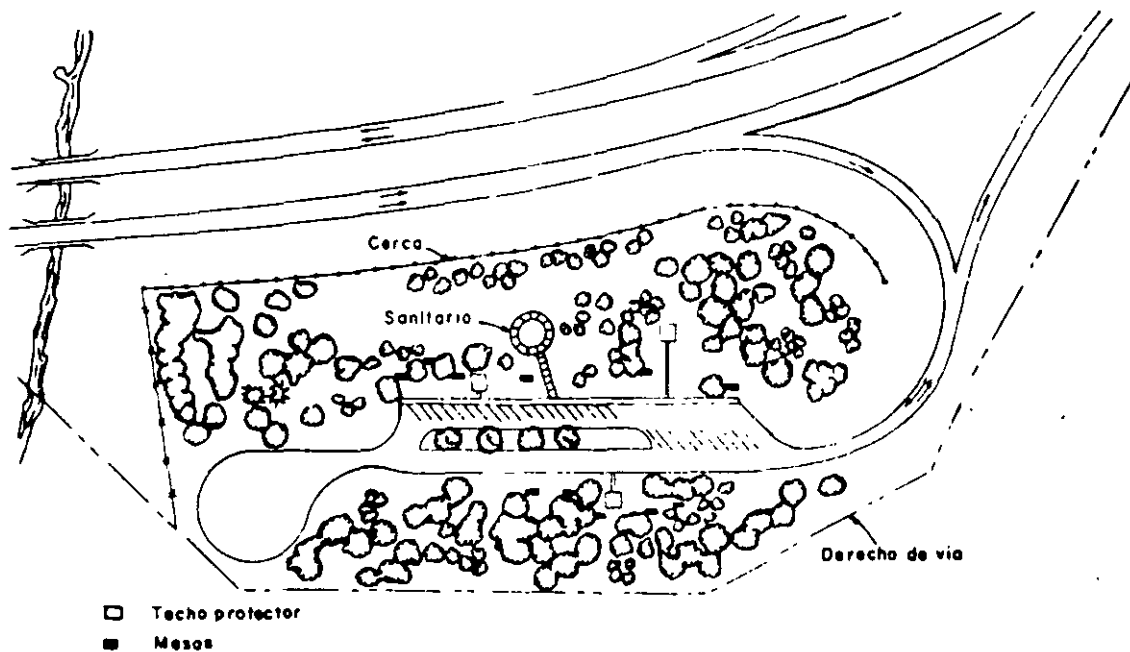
ZONA DE DESCANSO CUYO DISEÑO DEL ACCESO EVITA LA CONSTRUCCION DE UN PUEBTE SOBRE EL RIO
